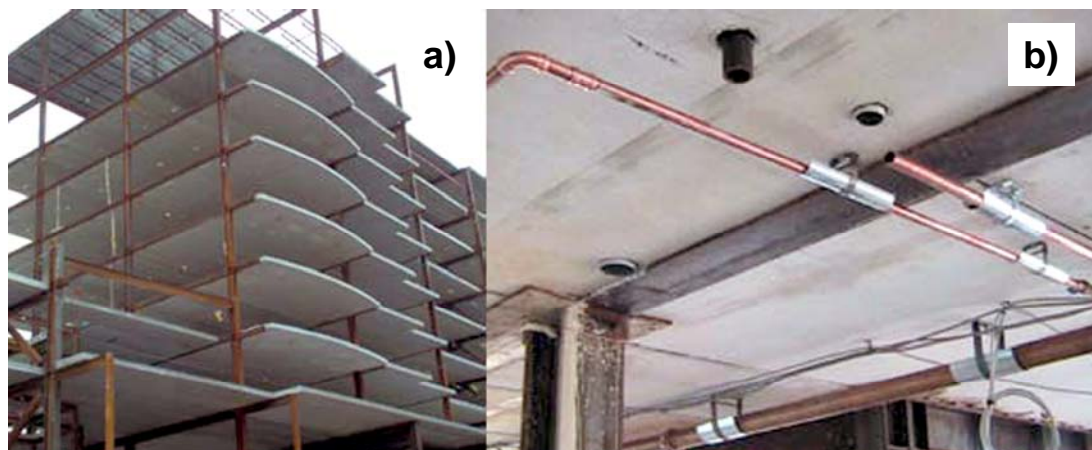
Laje livre (Fonte: Sistema Girder-Slab®)
